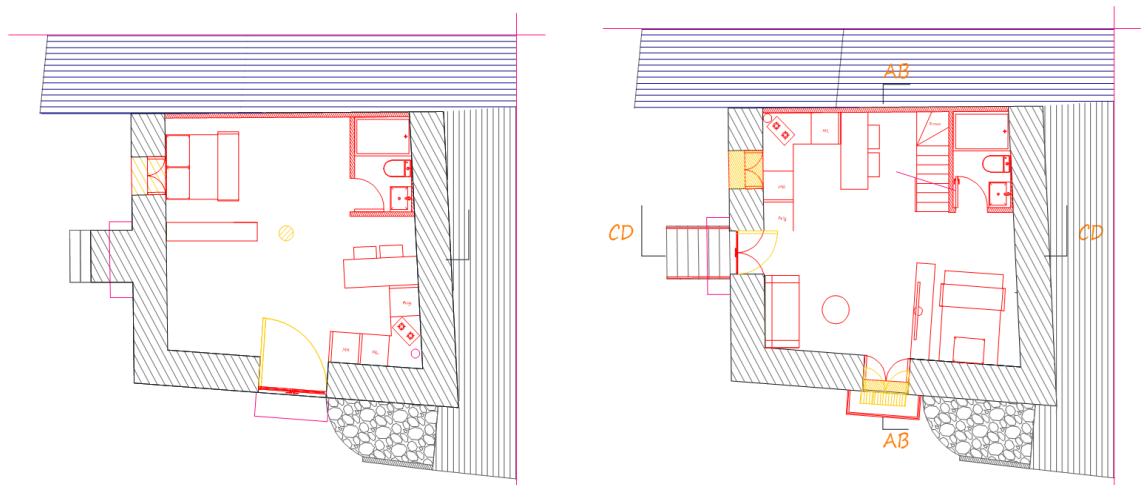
Plantas de alteração piso térreo e piso 1, vermelho e amarelo. Fonte: GANV
